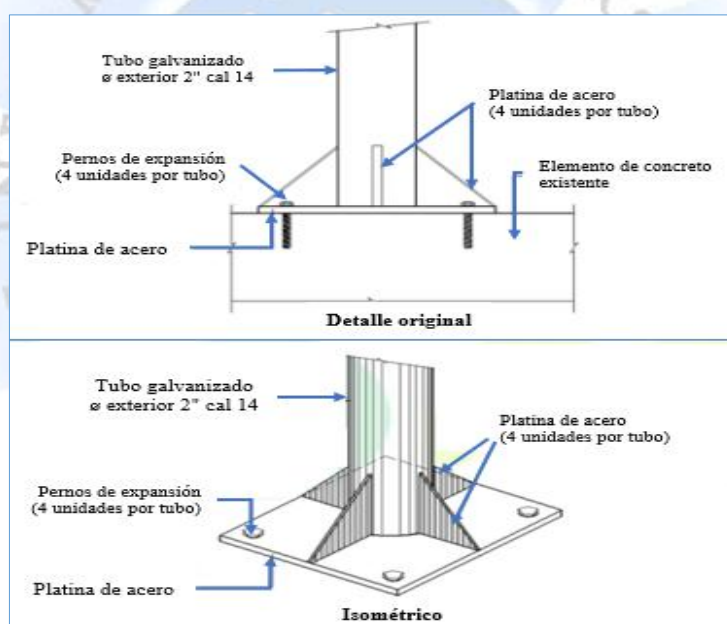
Detalle para anclajes de barandas de seguridad en obras
